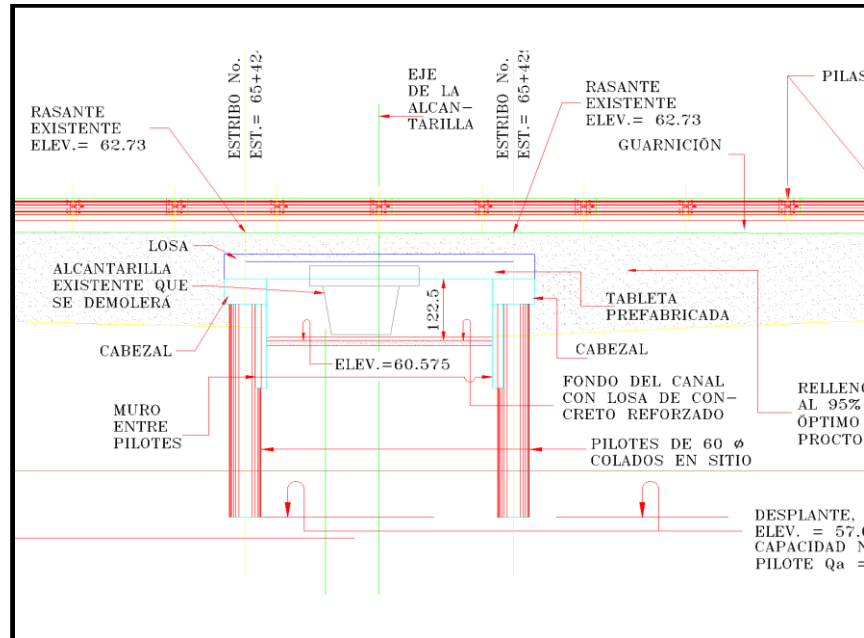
Alcantarilla existente donde se colocará la nueva alcantarilla.
